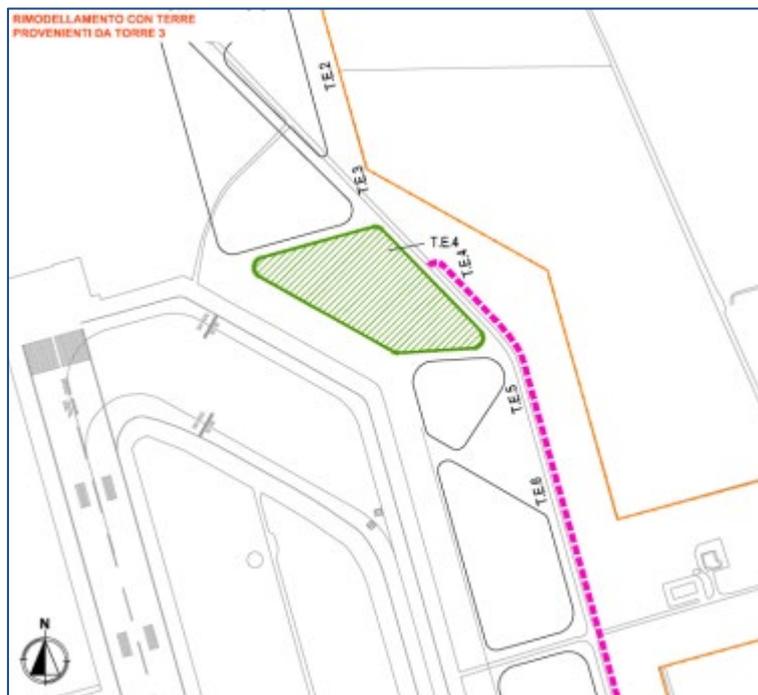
Ubicazione planimetrica del terrapieno di interesse progettuale, T.E.4
